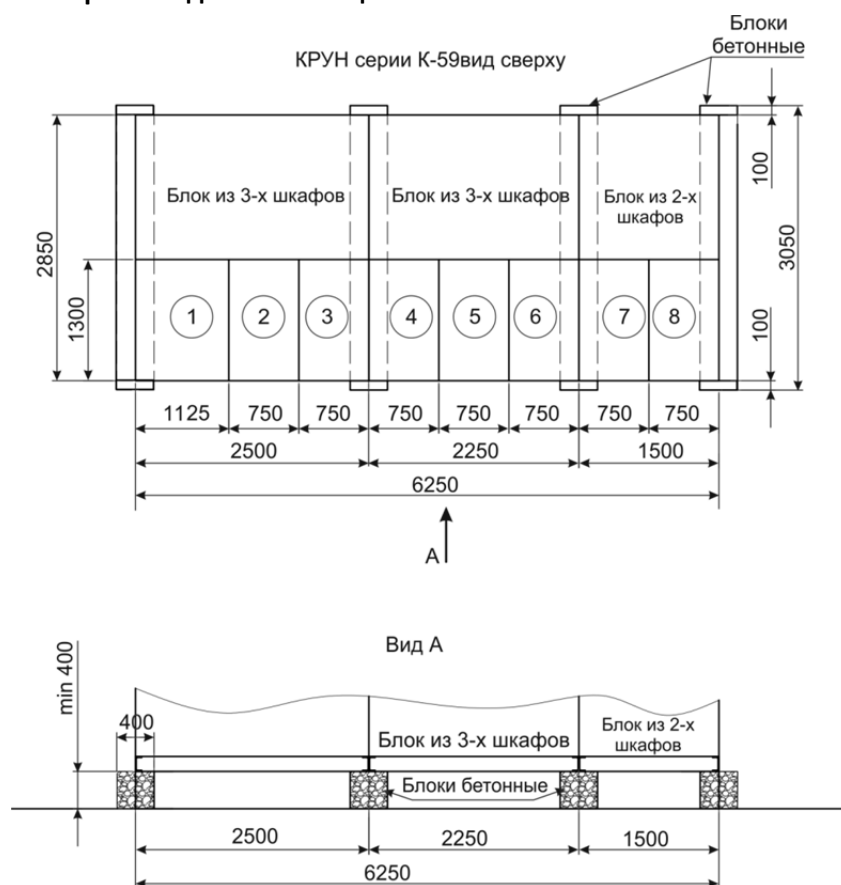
План фундаментов для различных размеров блоков КРУН К-59
